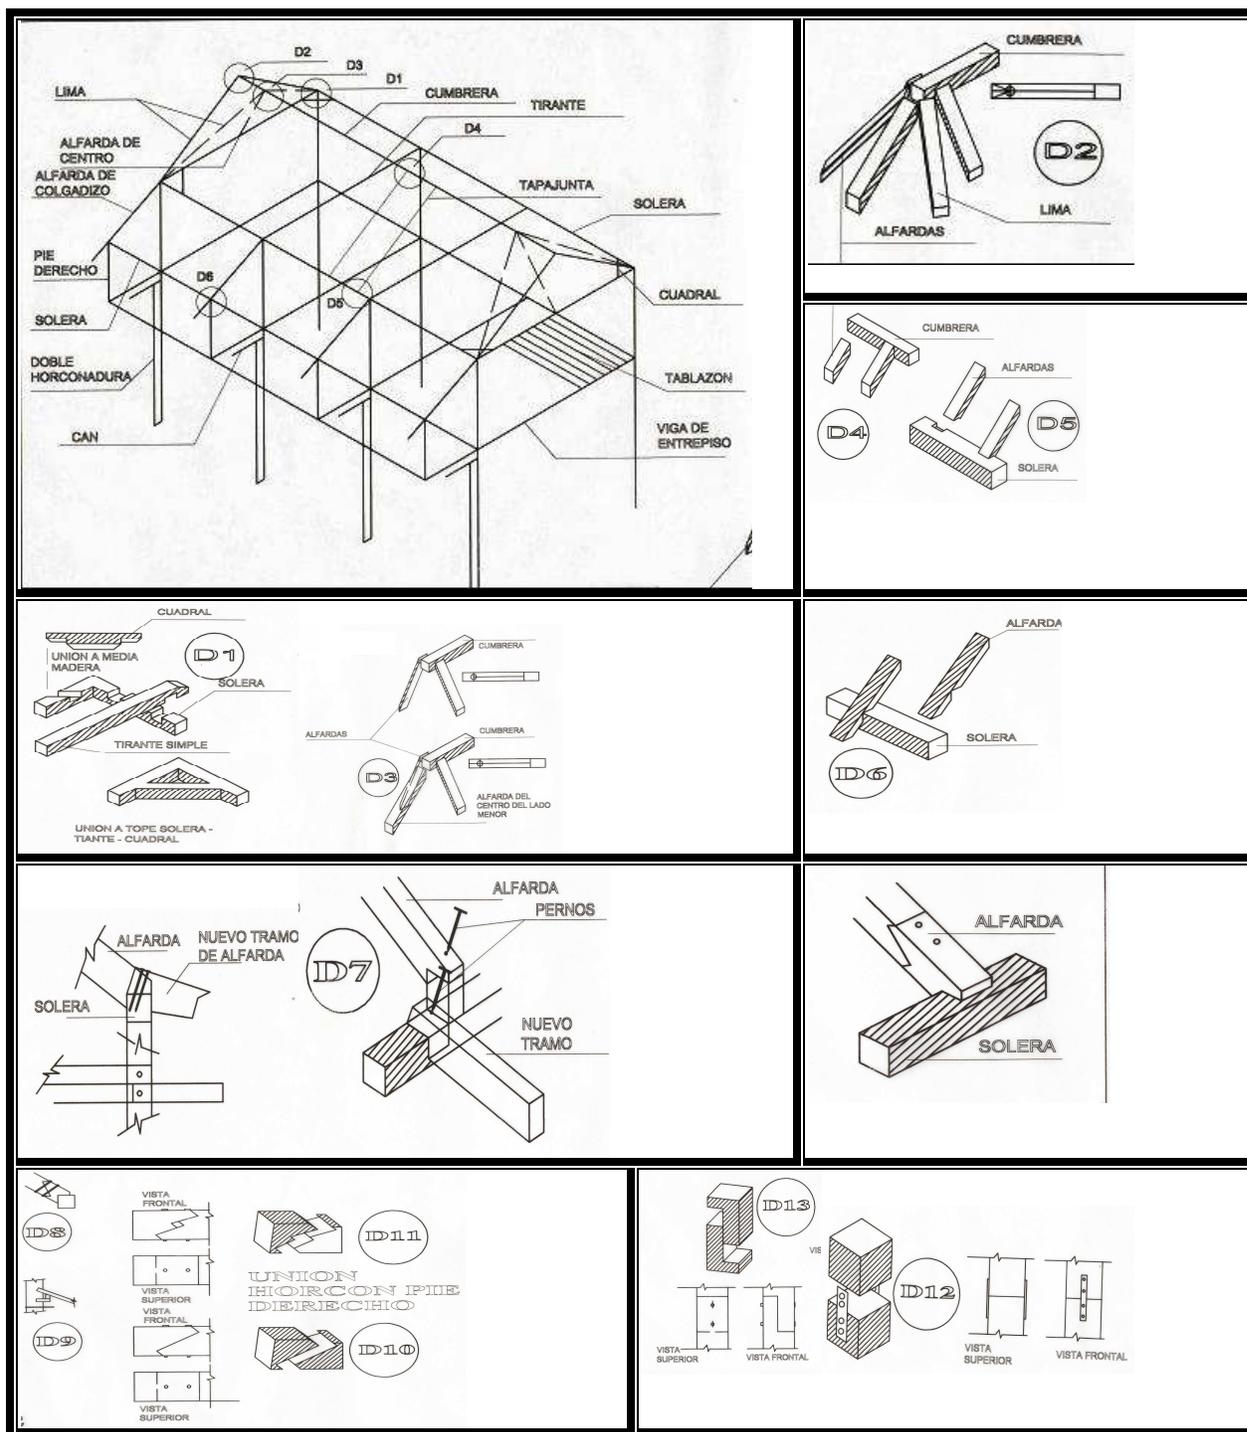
Detalles técnicos constructivos de las viviendas 40 84 .
